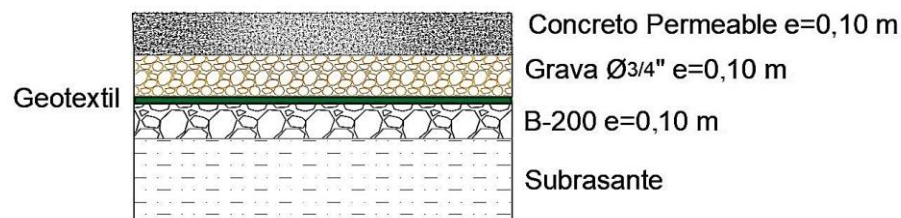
Estructura andenes peatonales pavimento poroso (Argos, 2018).
